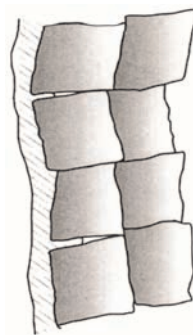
Resistencia al movimiento de bloques debida a la penetración del concreto lanzado en las grietas.
